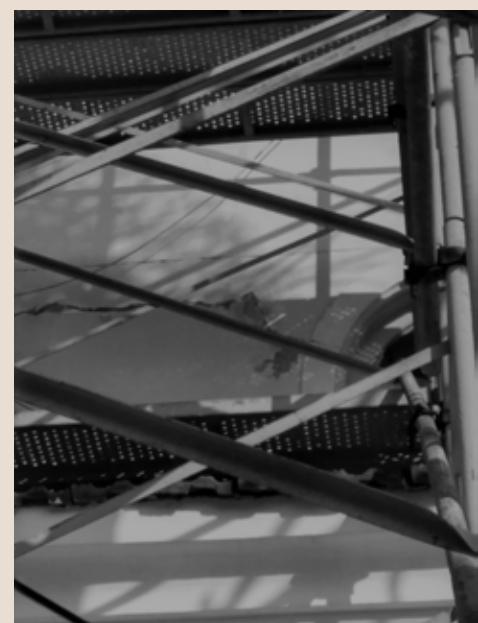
Fissura/rachadura na fachada sudoeste da Igreja. Fonte: Autoria própria, 2021.
